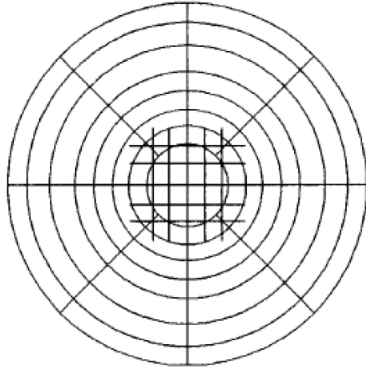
Disposição de armaduras em sapatas circulares (Cruz F. d., 2009)
